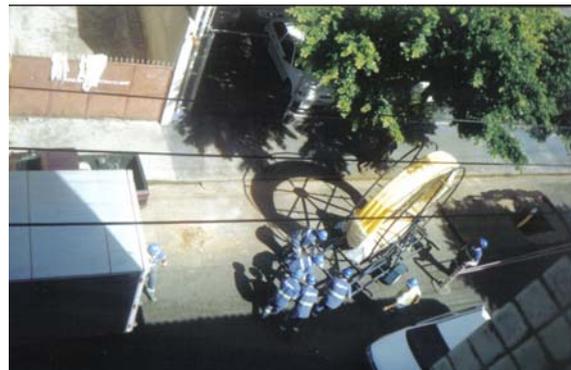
Vista de cima da implantação da rede de gás natural no bairro Santa Paula.
